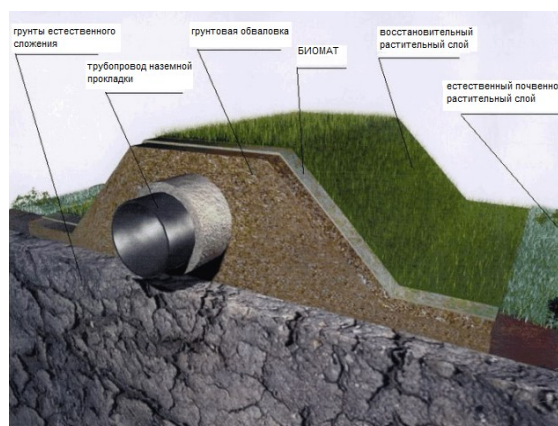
Закрепление биоматов на трубопроводах наземной прокладки
